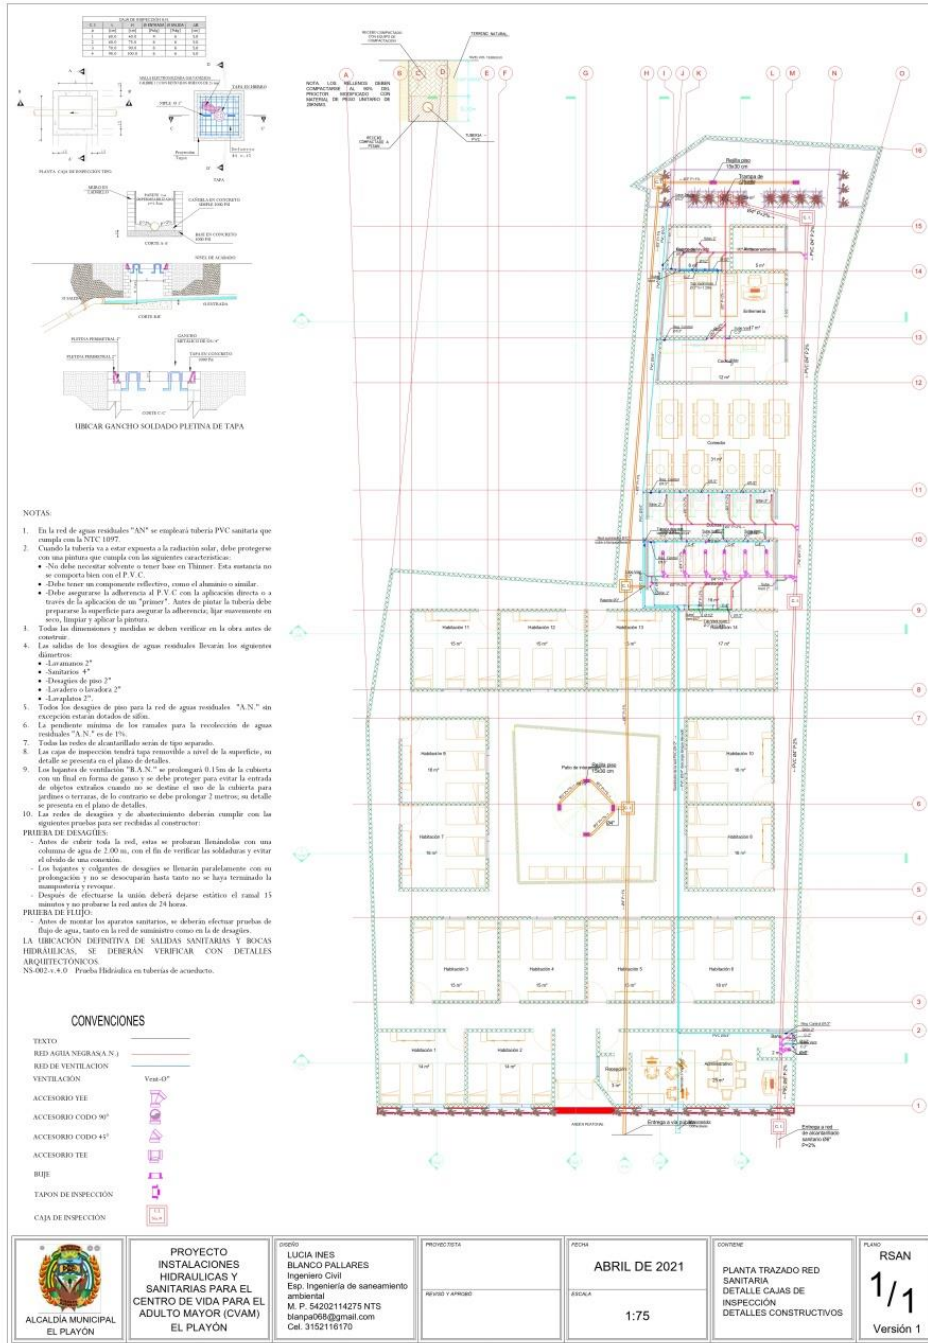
Planta Trazado Red Sanitaria, detalle Cajas de Inspección y detalles constructivos
